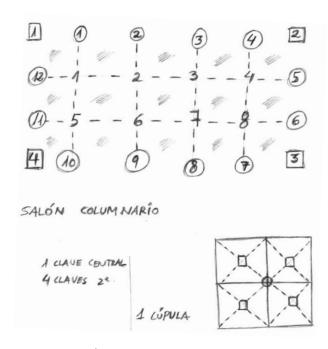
SALÓN COLUMNARIO. Distribución de columnas, cúpulas y claves. Fuente propia
